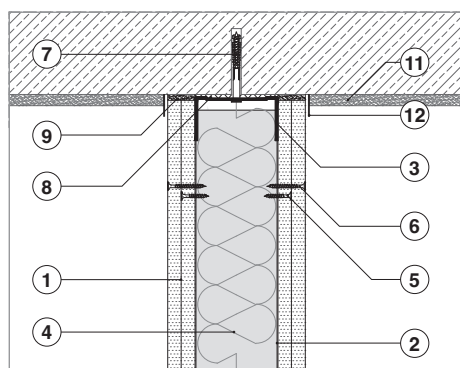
Conexiunea peretelui cu planșeu din beton armat, protecția plăcilor înainte de aplicarea tencuielii
